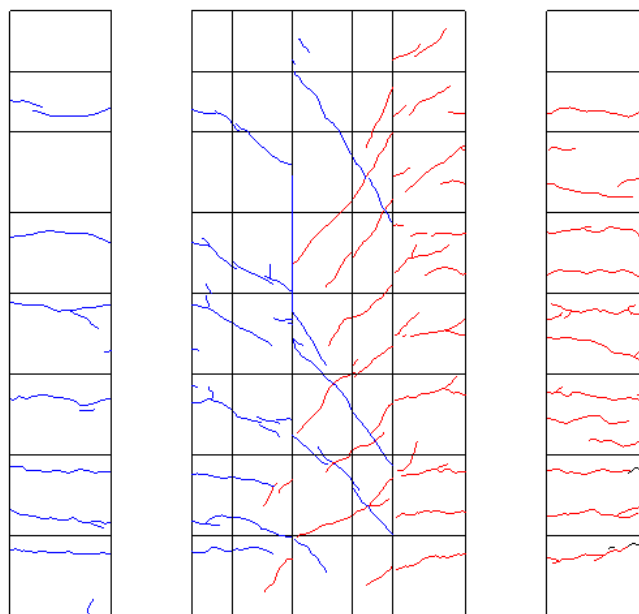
R=1/200②ひび割れ図
